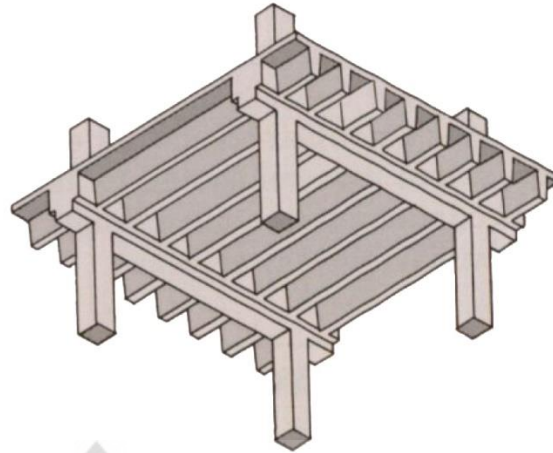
21 Konstruksi Lantai Jenis Waffle Slab
